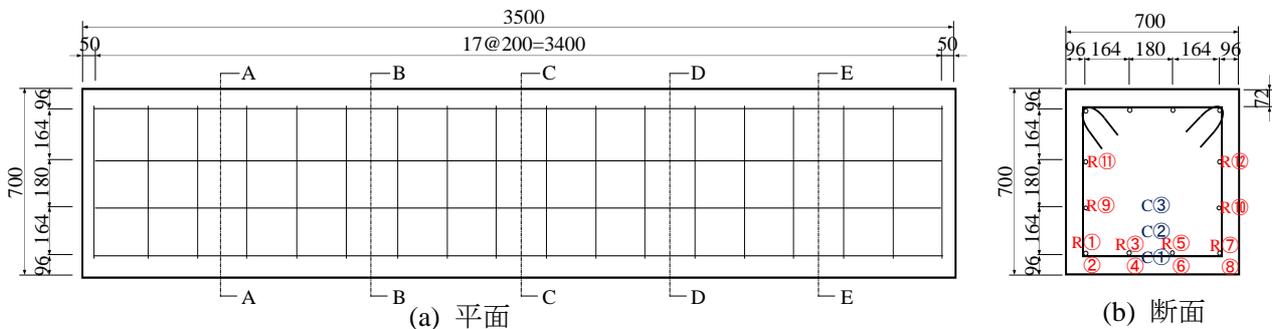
供試体の一般図と熱電対配置(寸法単位: mm)
